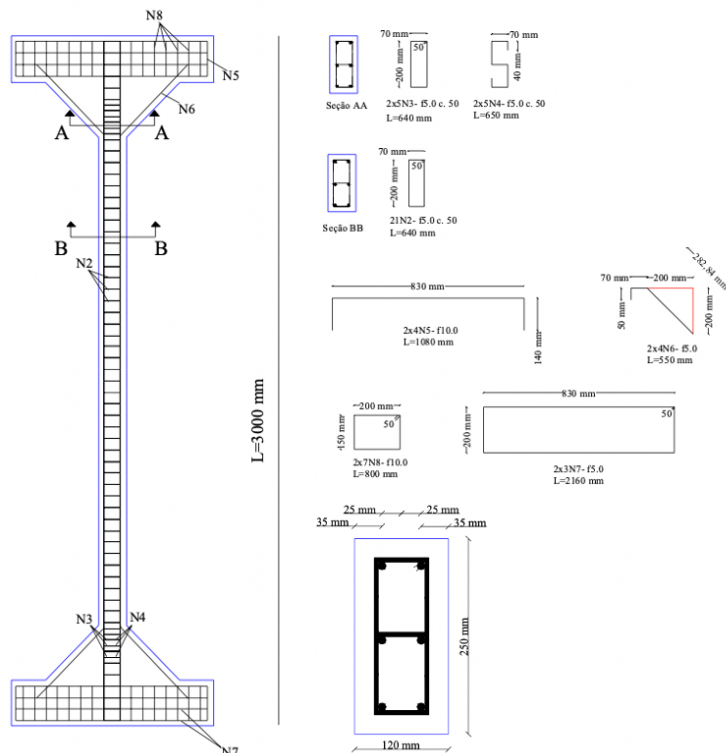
Detalhamento armadura pilar Dantas (2006)
